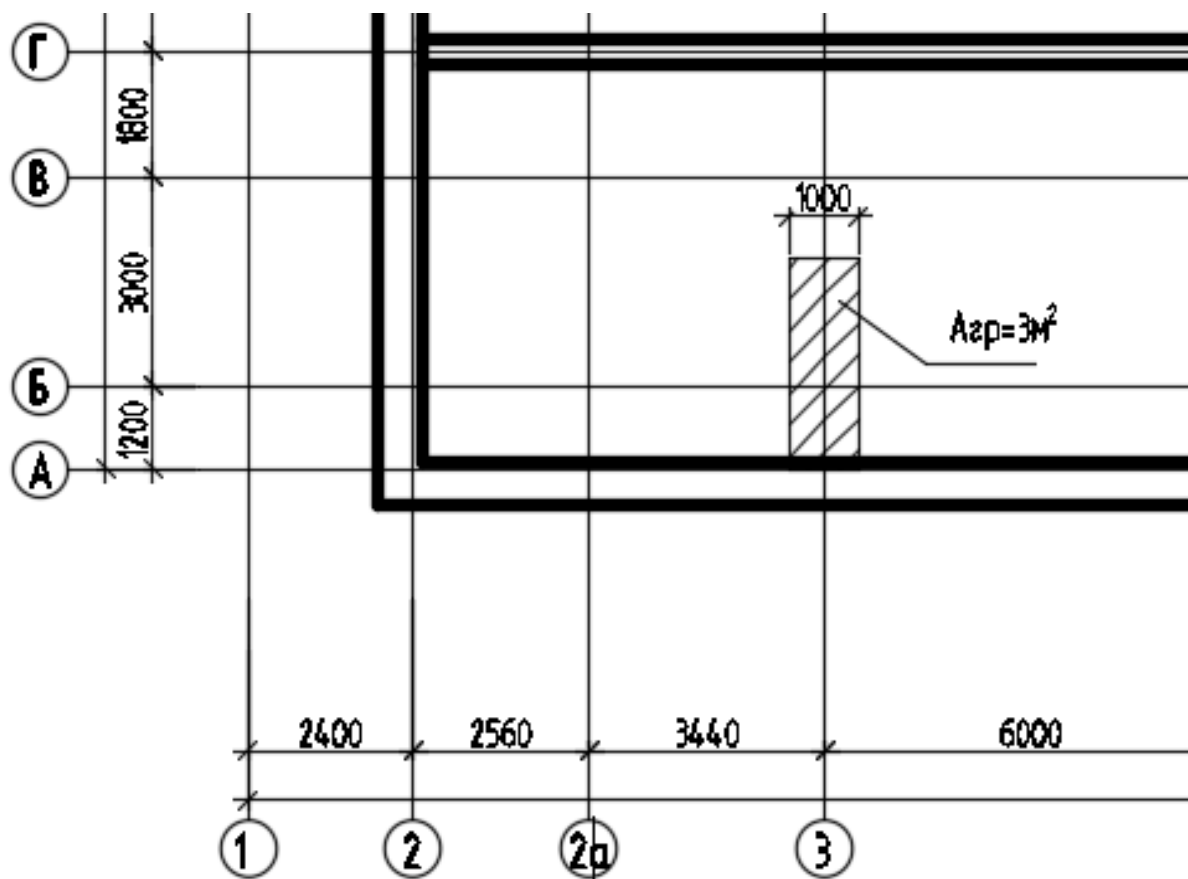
Грузовая площадь наиболее нагруженной крайней стены
